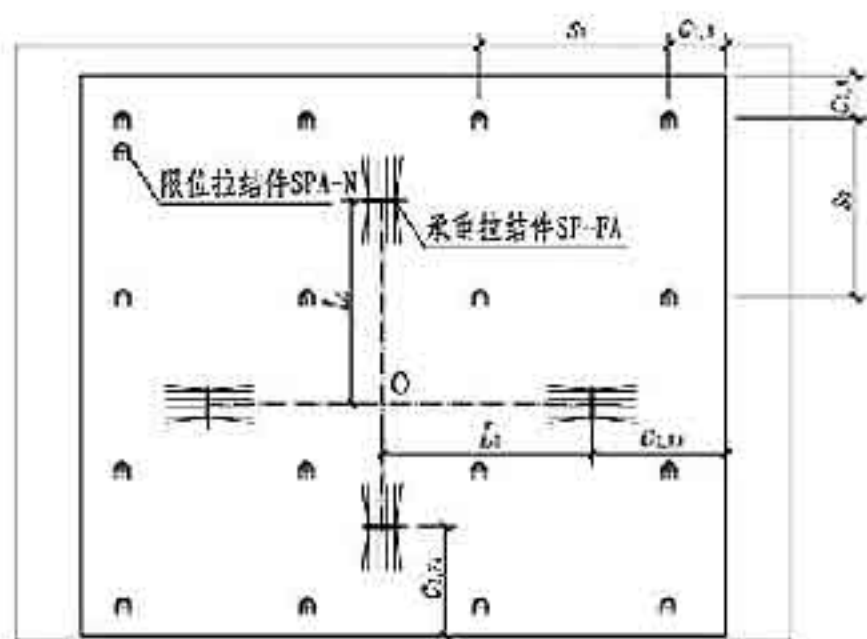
SP-FA和SPA-N系统拉结件平面布置示意图
